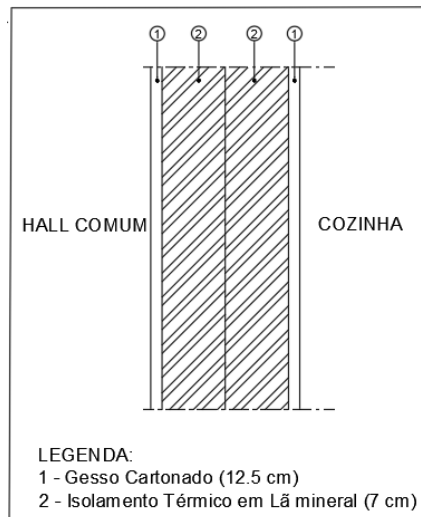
Pormenor construtivo da parede Cozinha/Hall Comum
